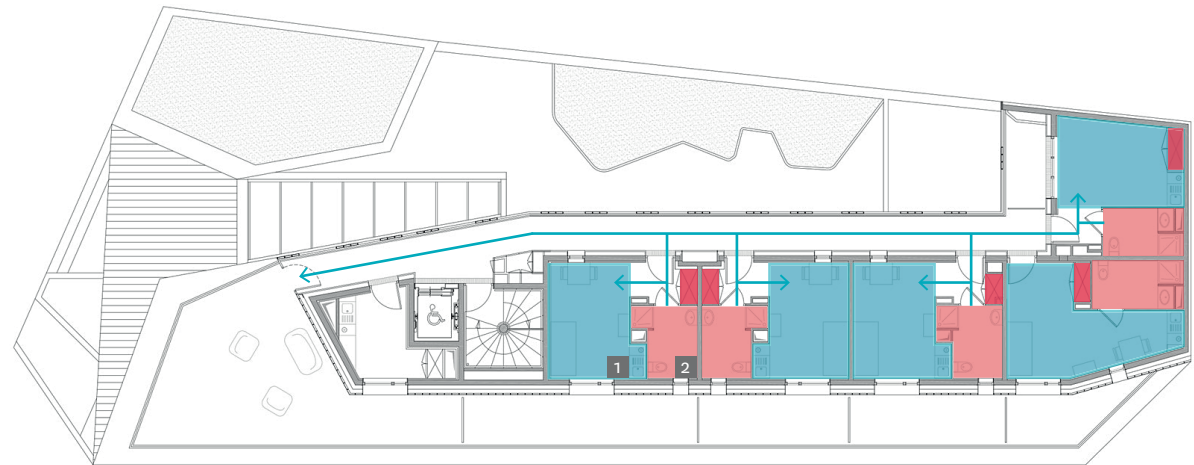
Unidad de vivienda, Tipo A, Planta 2-3
